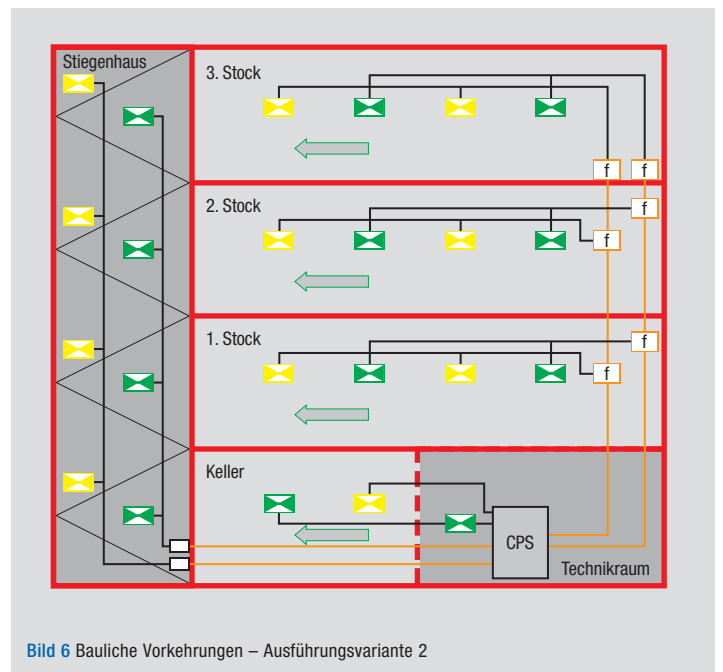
Bauliche Vorkehrungen – Ausführungsvariante 2
